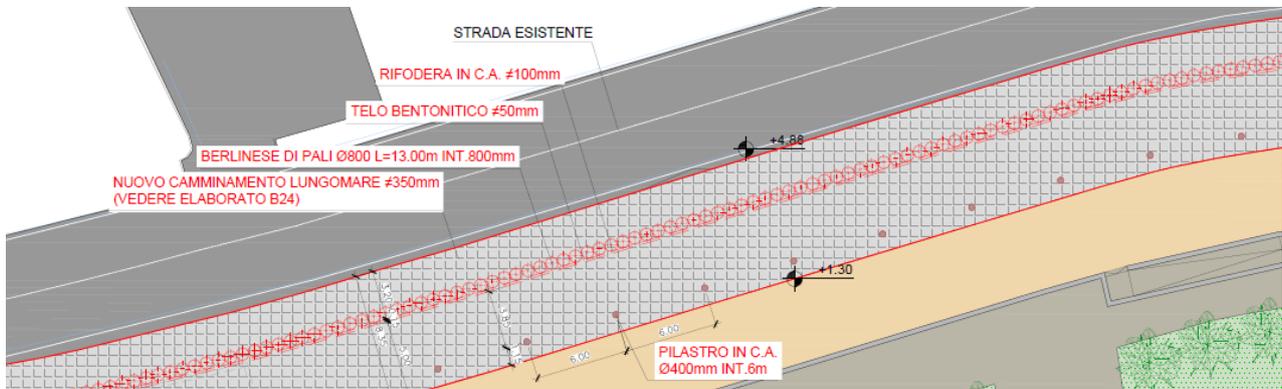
Estratto dalla Tavola C10 "Planimetria strutturale di progetto" - individuazione della berlinese
